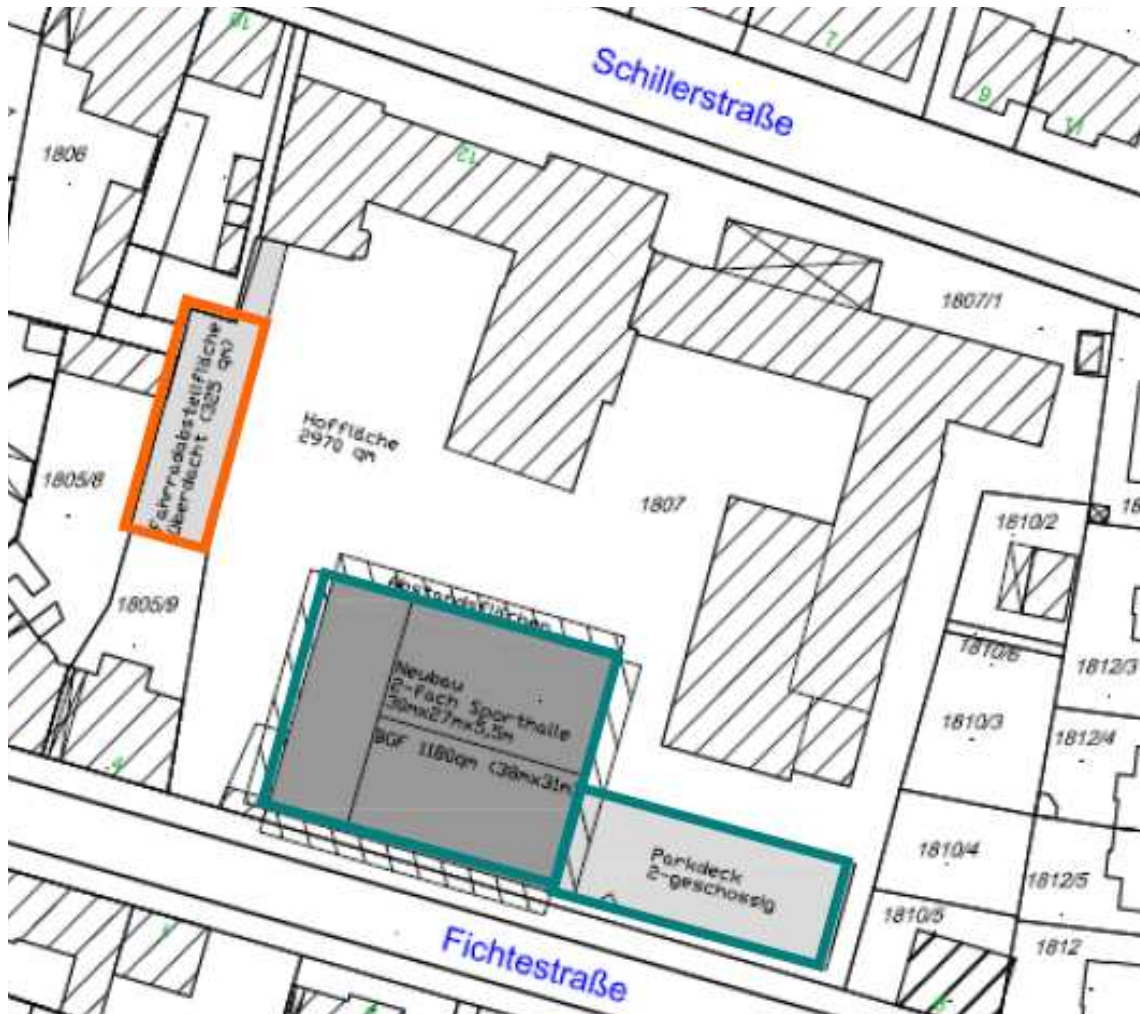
Lageplan mit Darstellung der 2-fach-Sporthalle mit Parkdeck (grün eingerahmt) sowie eines Fahrradunterstandes (orange eingerahmt)
